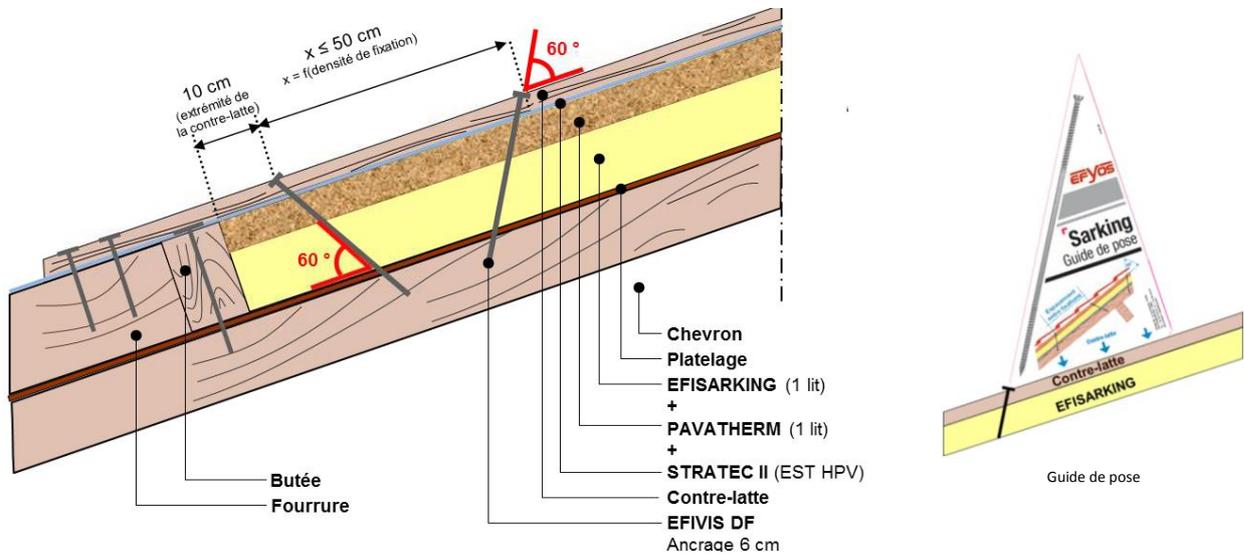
Fixation des EFIVIS DF -EFISARKING épaisseur $\geq 160 \text{ mm}$ ou EFISARKING + PAVATHERM/EST
